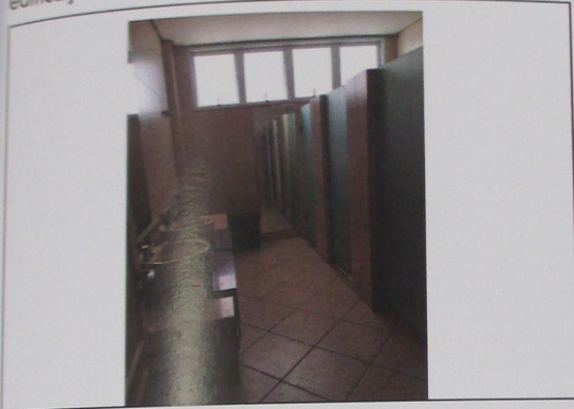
Vista do Vestiário Masculino da edificação construída no lote vizinho.
